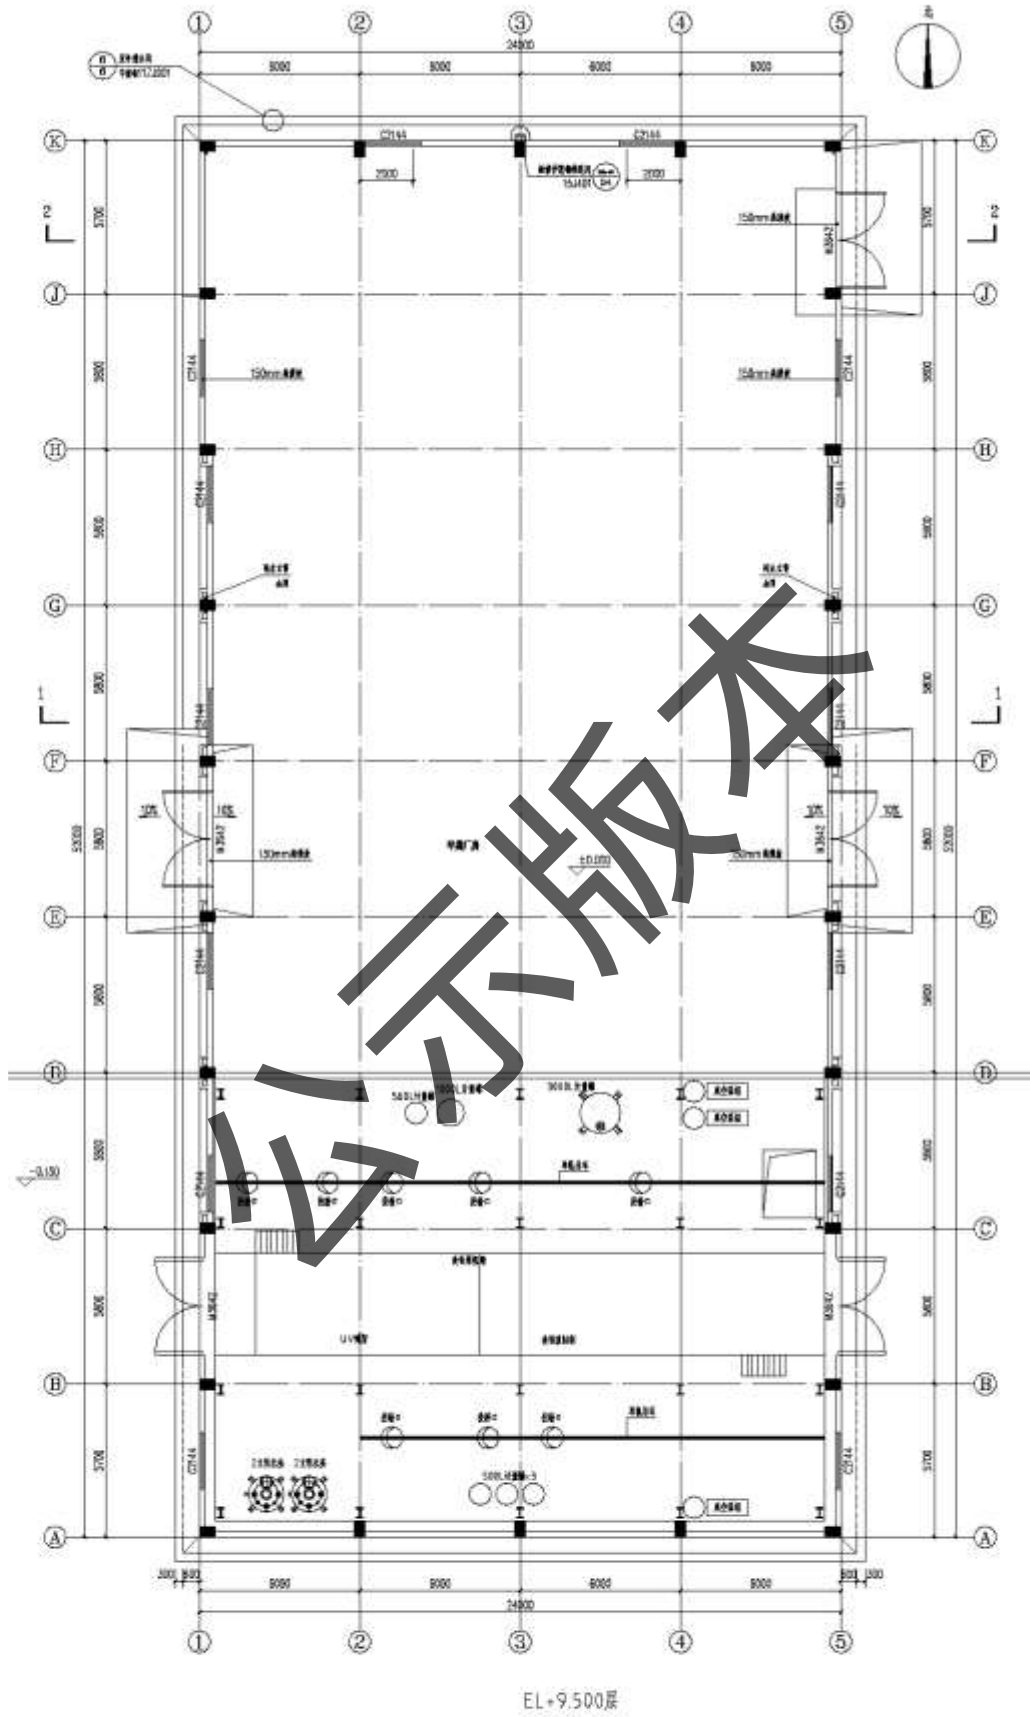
甲类厂房平面布置图（三层钢平台）
